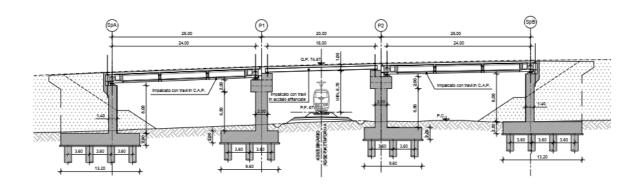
Cavalcaferrovia NW04 – Sezione longitudinale
